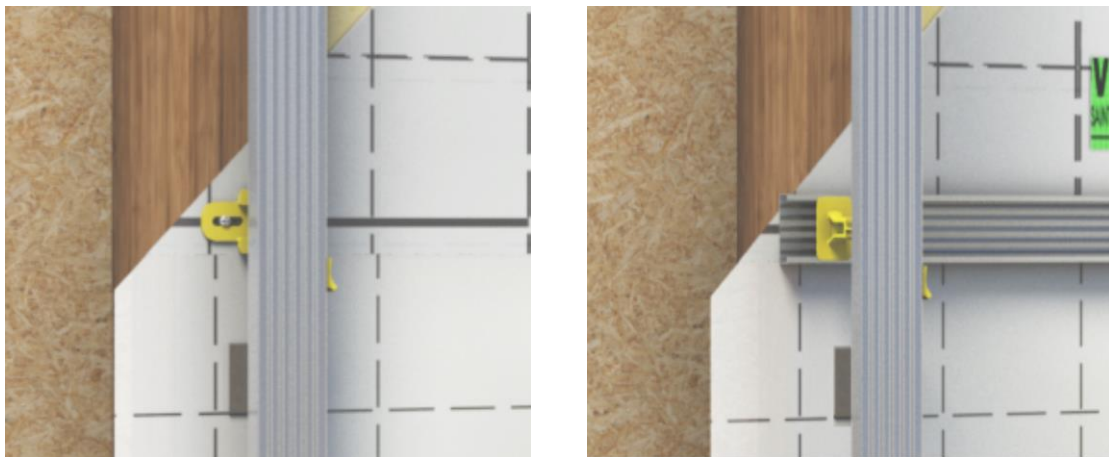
Montage avec ossature secondaire bois : après la pose de la membrane, vissage des tasseaux bois sur les fourrures, puis de la plaque
